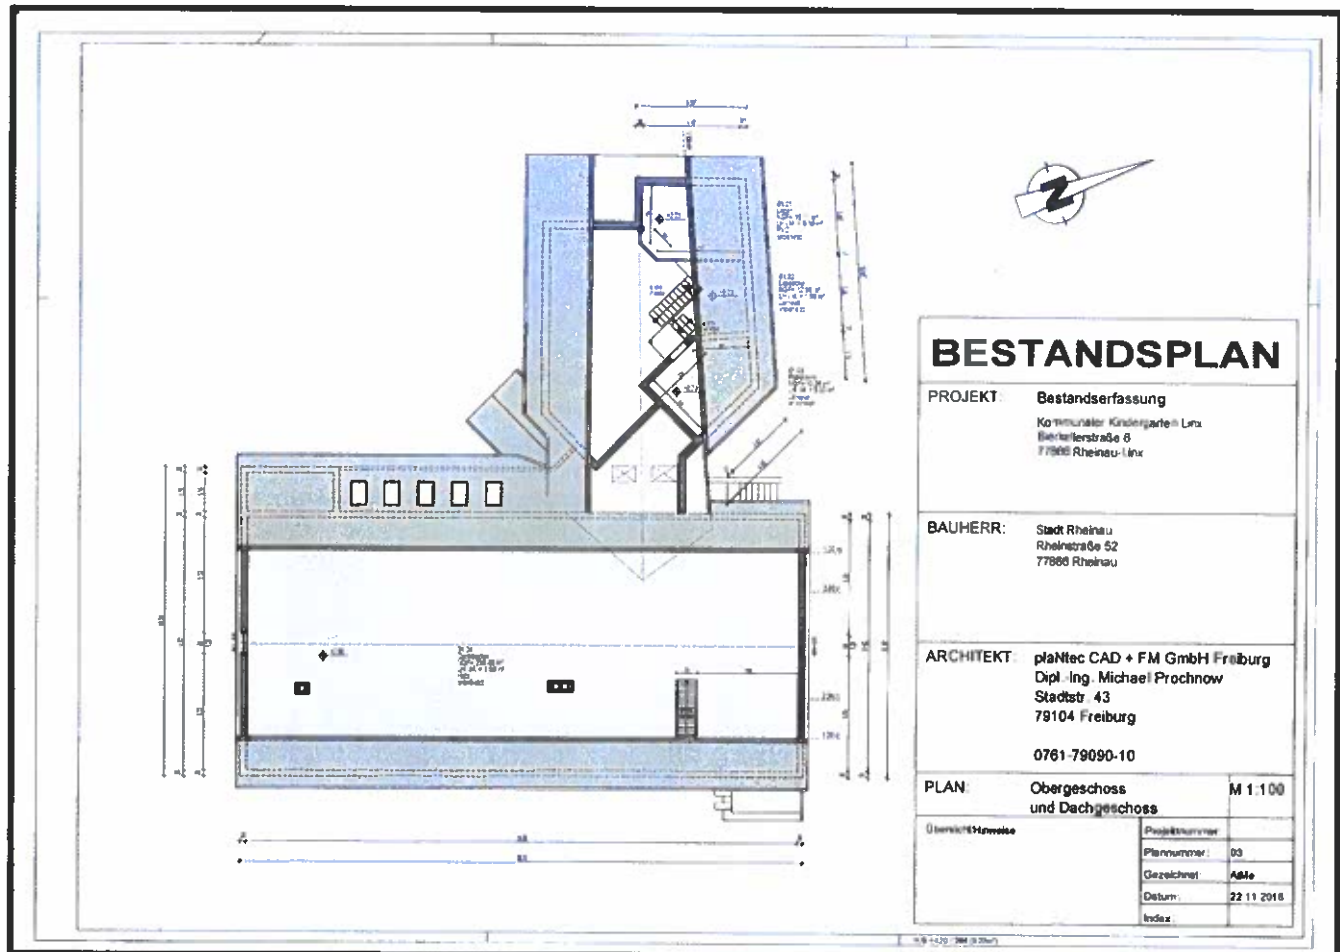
Grundriss des Ober- und Dachgeschosses
